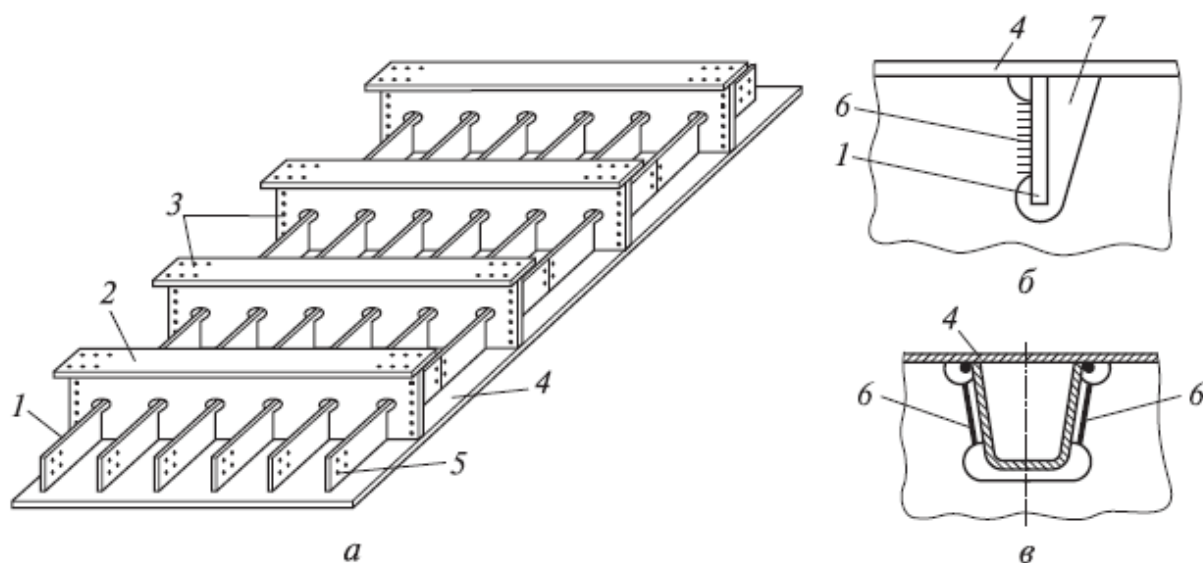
Вид снизу (а) на монтажный блок ортотропной плиты и узлы (б, в) пересечения различных продольных ребер со стенкой поперечного ребра:
